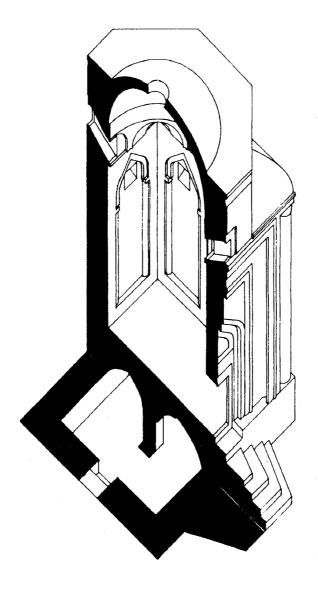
مسقط أفقى لتربة إبراهيم باشا في فوتچا (عن : Paŝić) .
